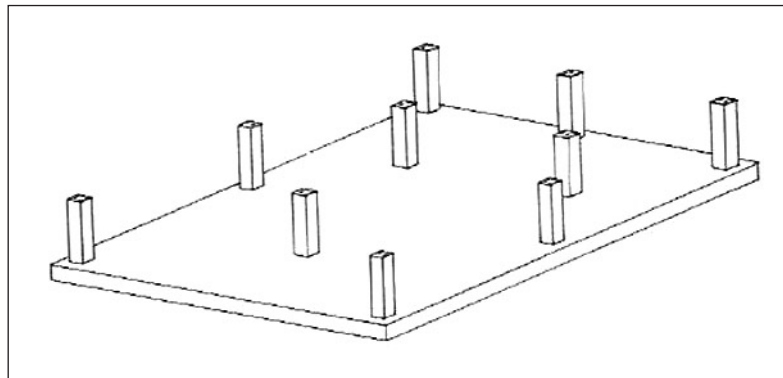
LOSAS DE CIMENTACIÓN EN PILAS.
